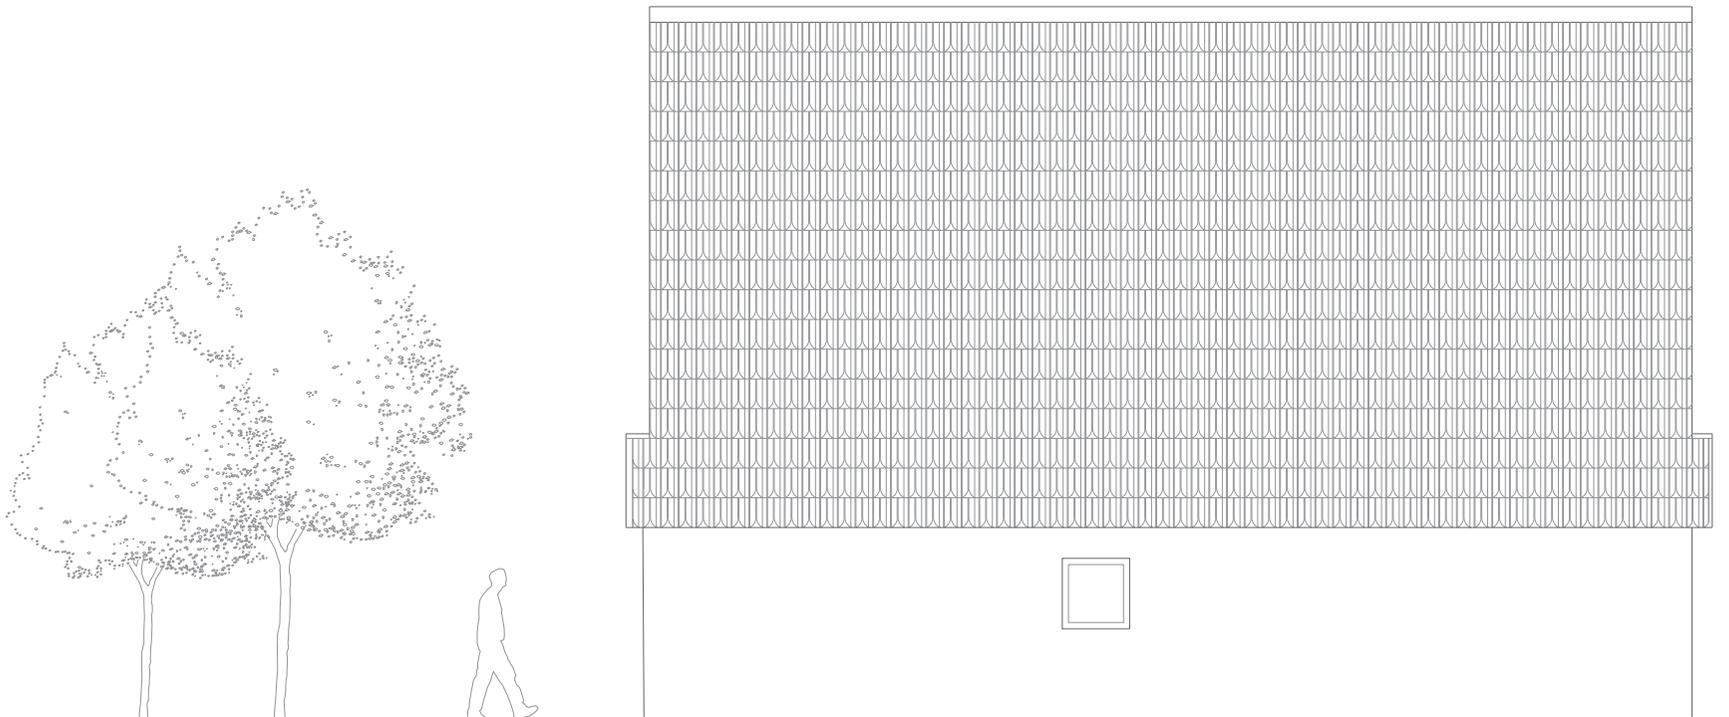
Fachada norte. Escala 1/75. Fuente : Carlos Fuster Aparisi
